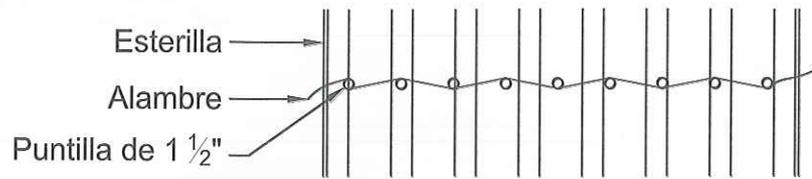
Detalle de fijación y alambrado de la esterilla sobre los marcos
